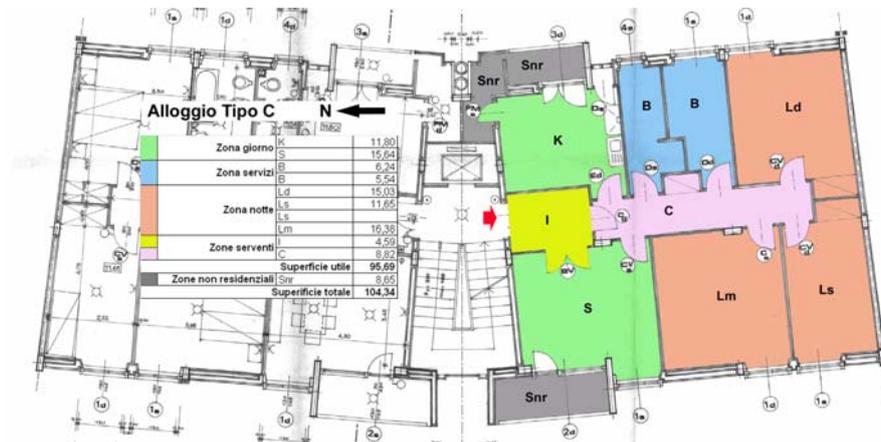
Pianta del progetto originario dell'alloggio tipo C da 90 mq per 7 persone
